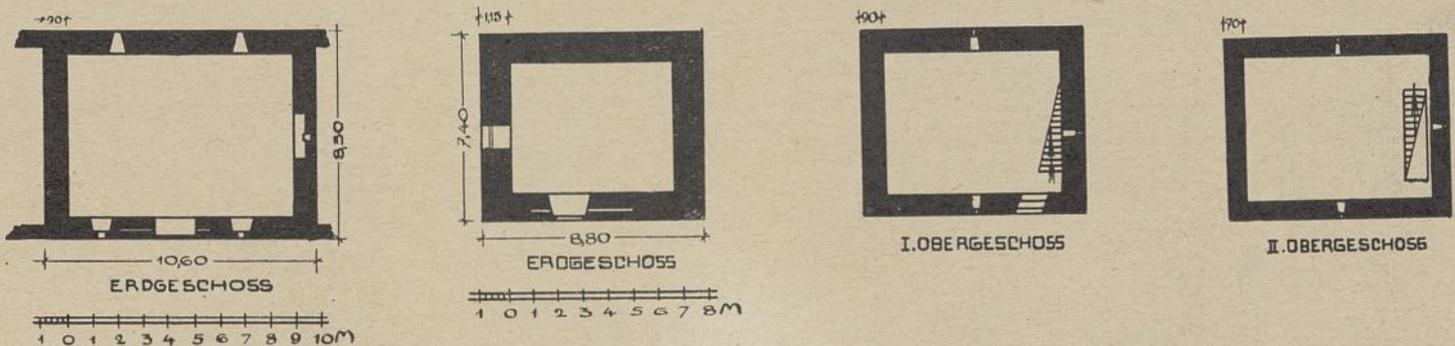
Bergfried Wittmar, Grundrisse M. 1:300.
